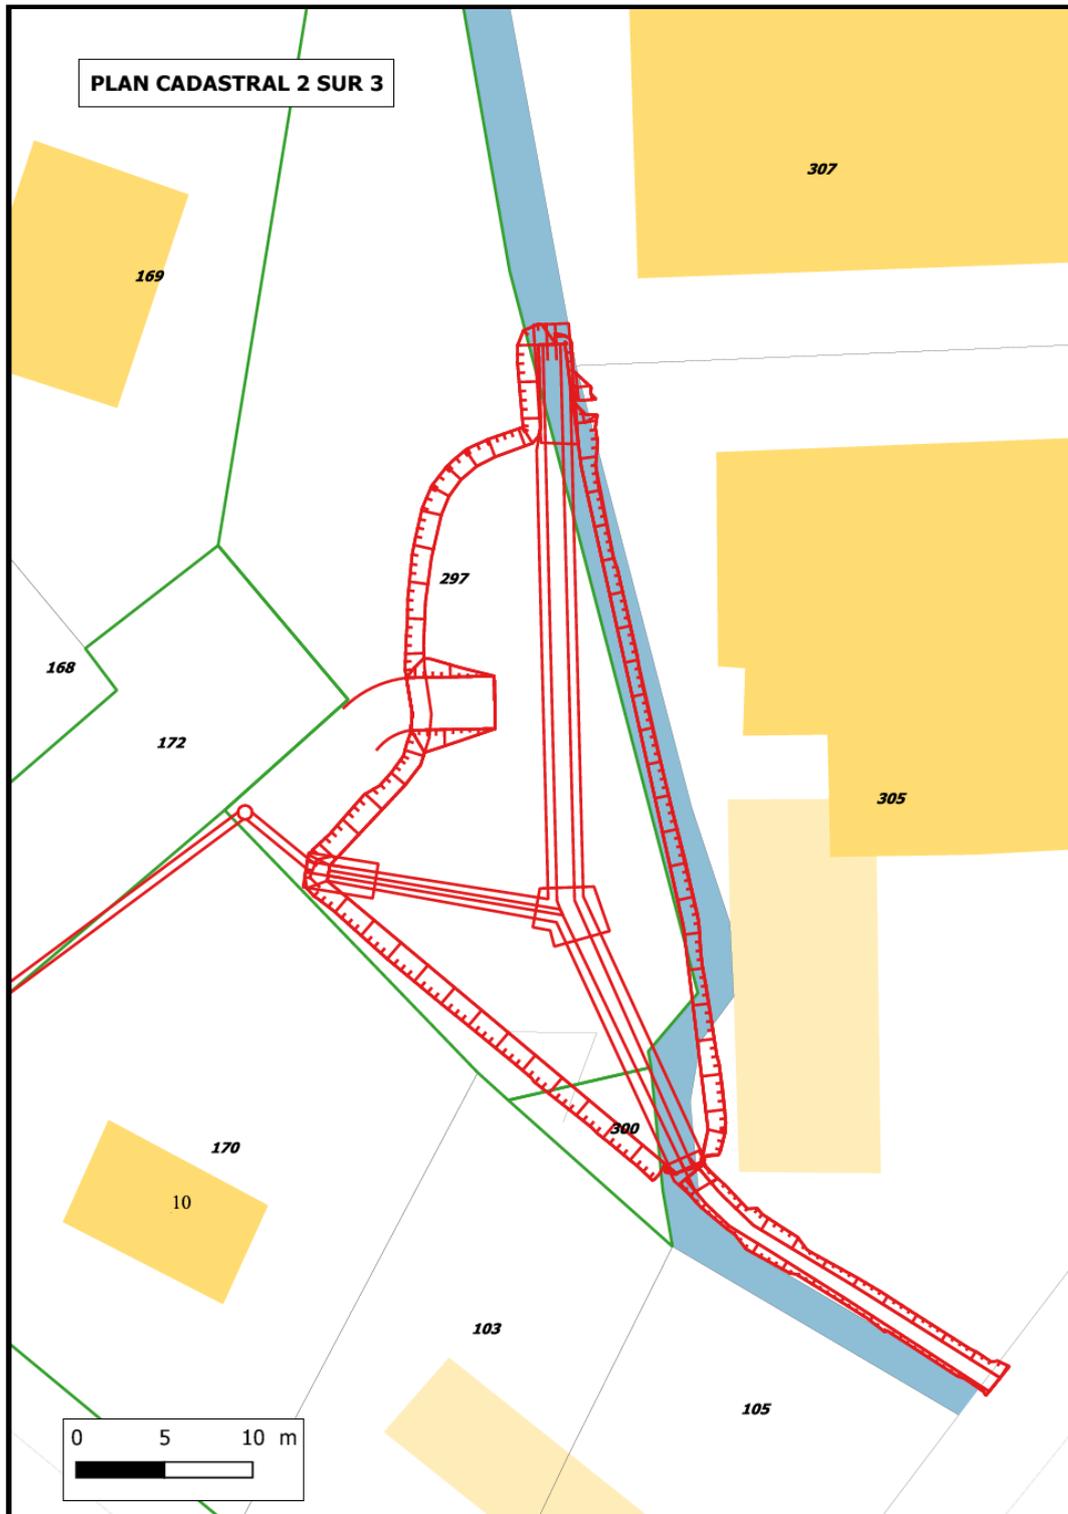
Extrait de l'annexe 3 : plan cadastral 2 sur 3
